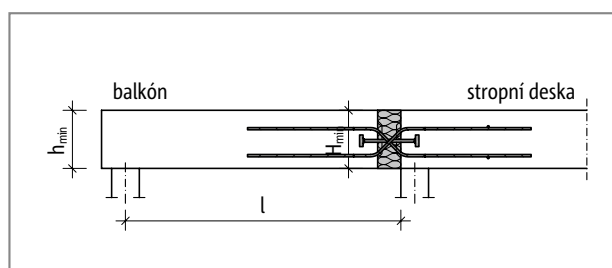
Schöck Isokorb® typ QP70L až QP80L: Statický systém
